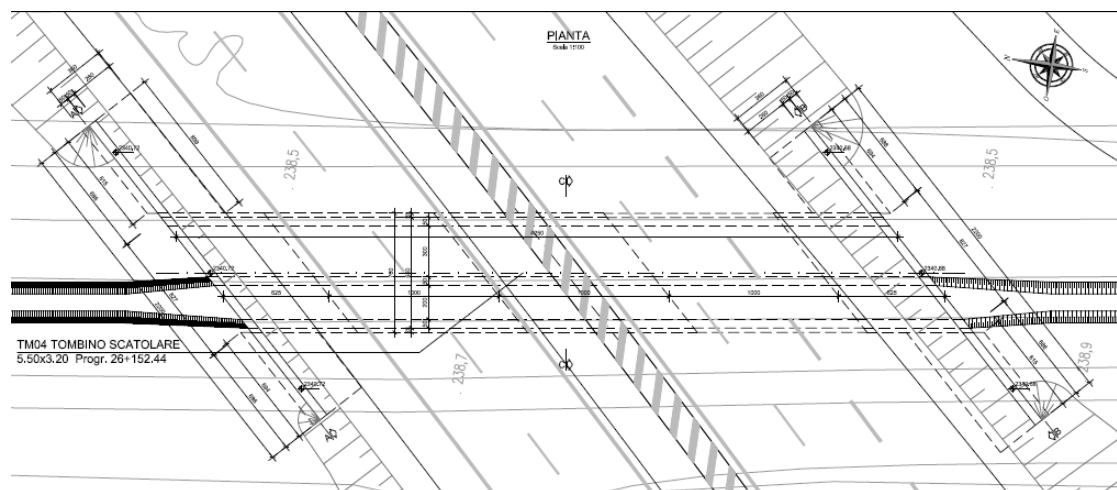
Tombino per attraversamento canale irriguo – Vista in pianta
